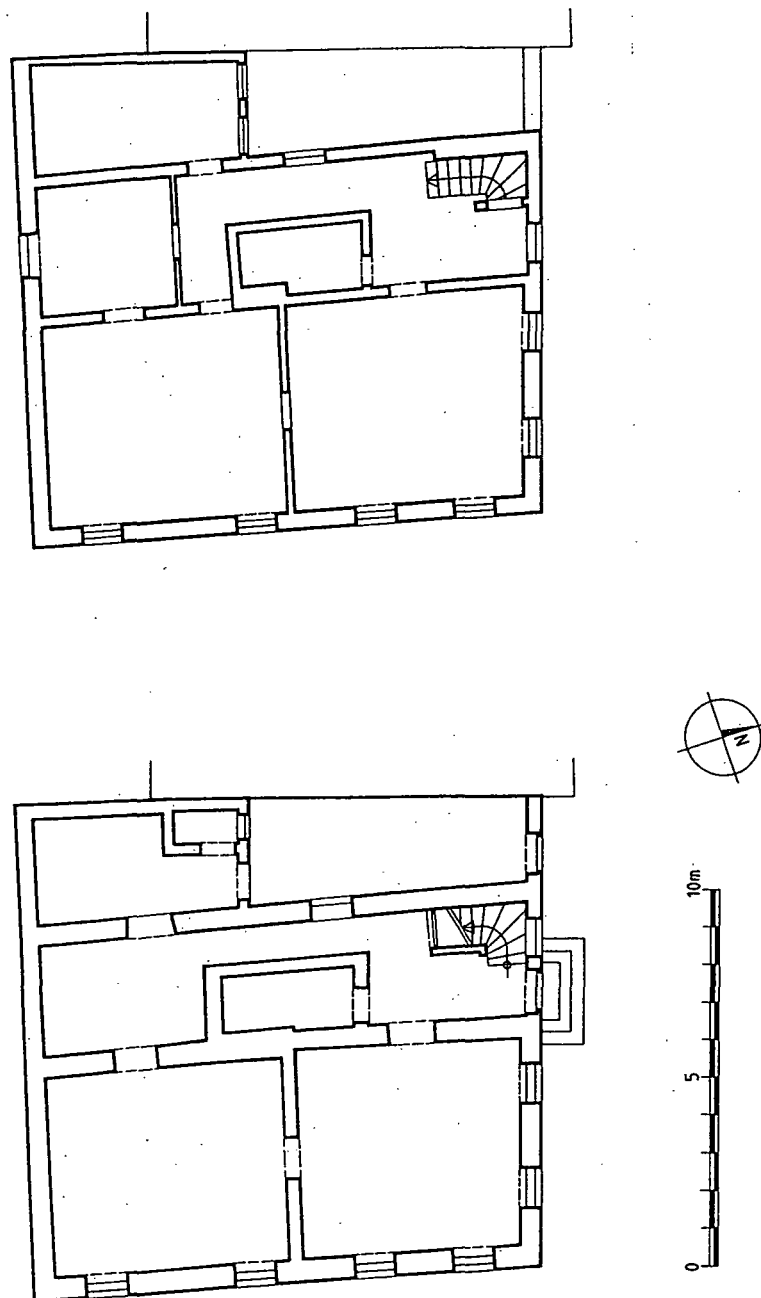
Kirchenplatz 10 – Grundrisse Erdgeschoss, Obergeschoss (1:200).
